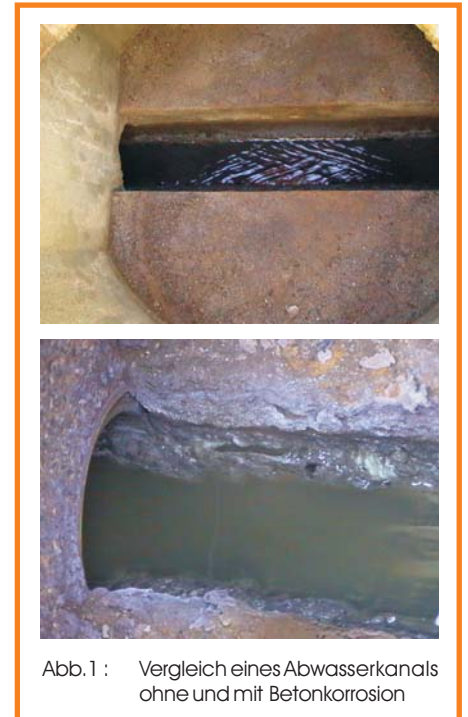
Vergleich eines Abwasserkanals ohne und mit Betonkorrosion
